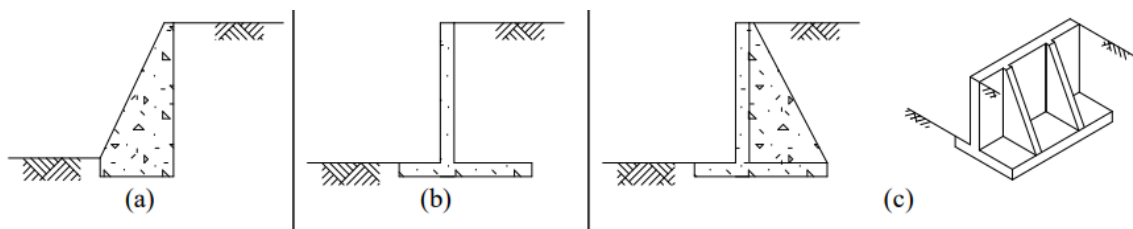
Tipos de estrutura de suporte rígidas: a) muros de gravidade; b) muros de flexão; c) muros contraforte. Adaptado de Fernandes (2015).
